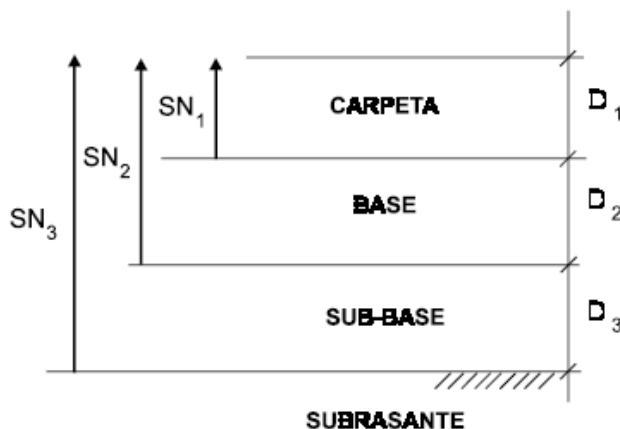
Sistema multicapa pavimento flexible Fuente: Diseño de Pavimentos AASHTO
